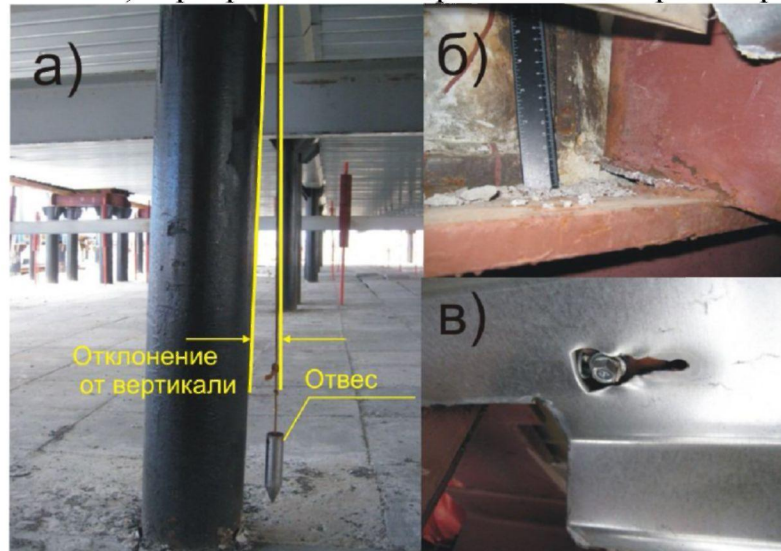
Признаки движения и напряженного состояния конструкций при пучении грунтов свайного основания: а) отклонение от вертикали свай; б) разрыв сварных швов в ростверке; в) след подвижки основания крепи профнастила
